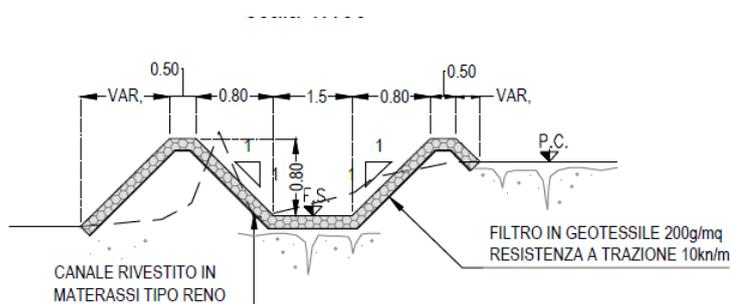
Sezione tipo del canale trapezio rivestito in materassi reno
